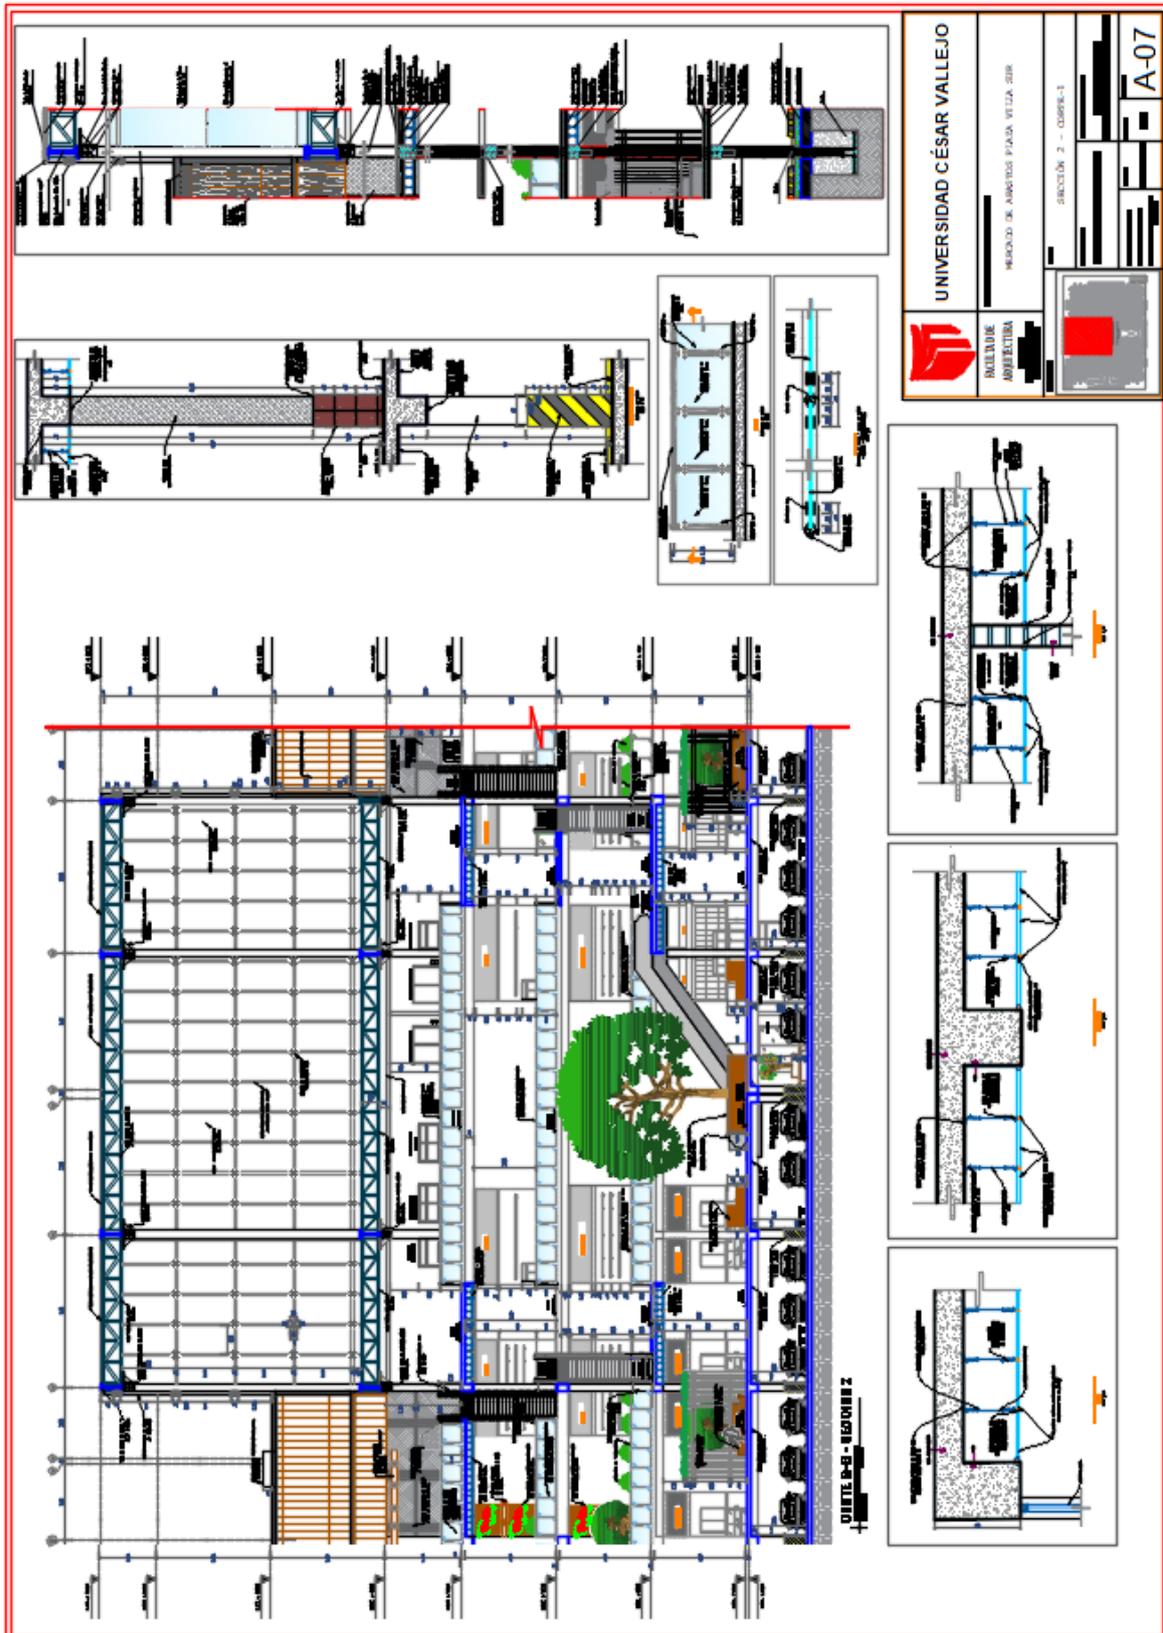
Plano de Arquitectura – Plano de secciones – plano de cortes
